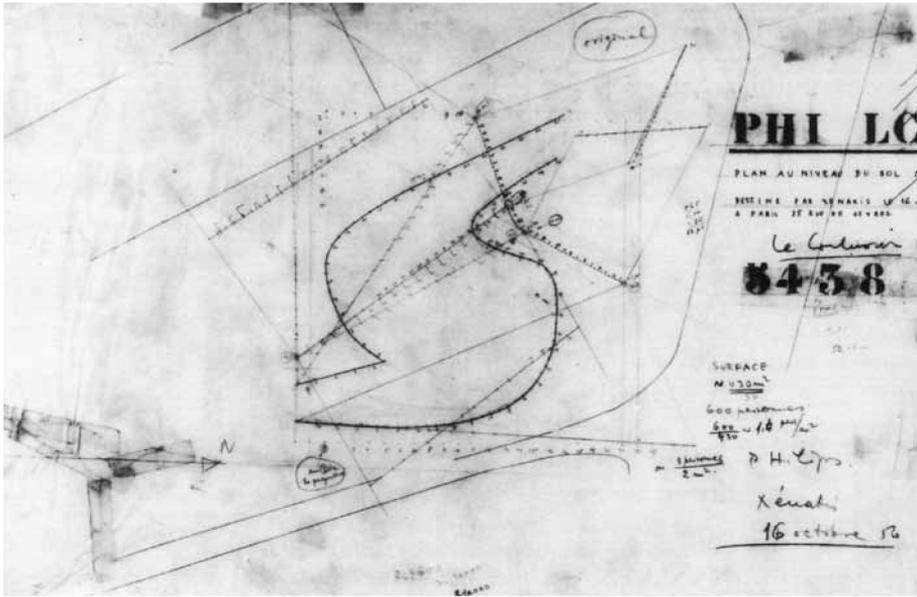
Skizzen Grundriss und Formentwicklung des Philips Pavillons
